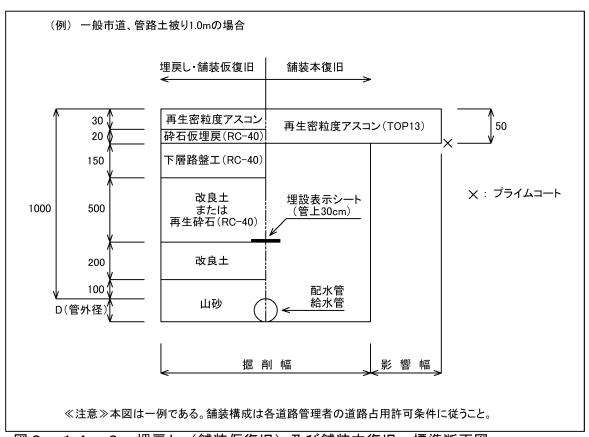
埋戻し(舗装仮復旧)及び舗装本復旧 標準断面図
